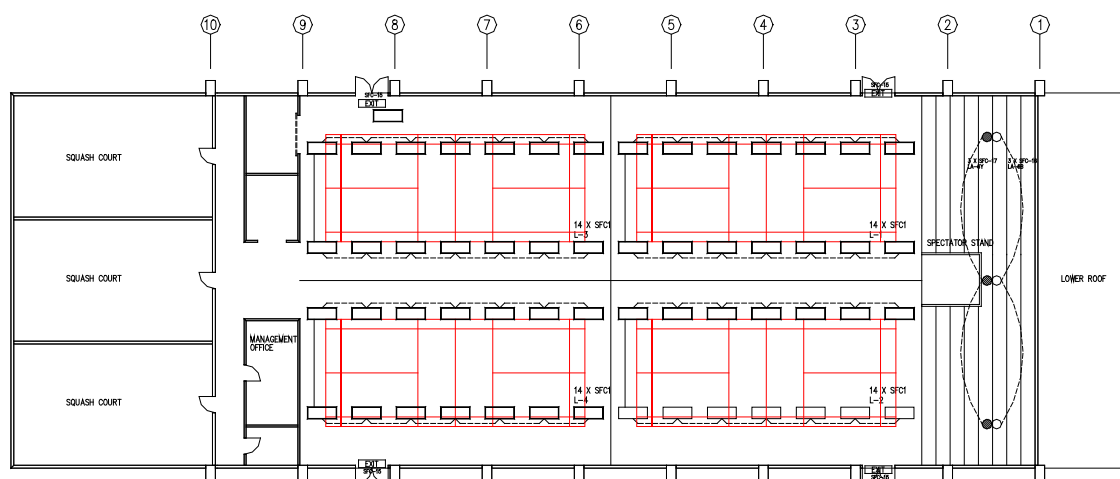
：东启德室内运动场新高输出 T5 照明系统平面图
